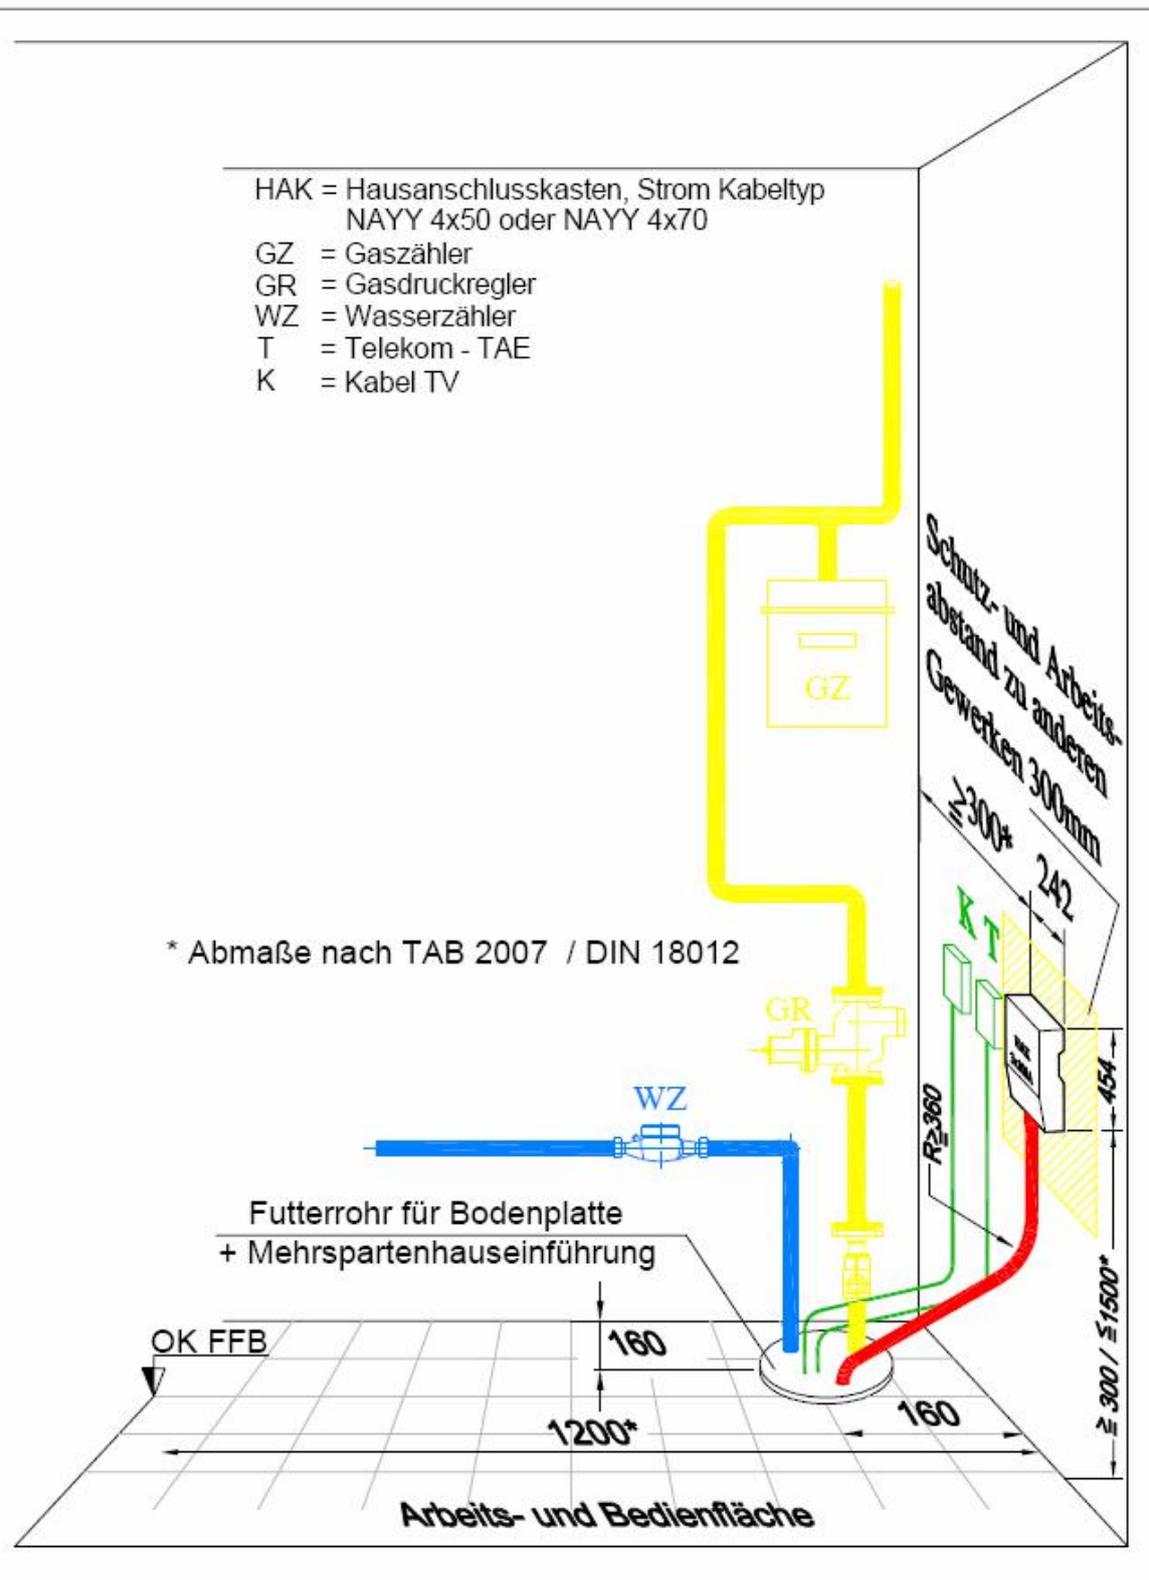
Installationsvariante Mehrspartenhausanschluss, vertikaler Einbau für nicht unterkellerte Gebäude
